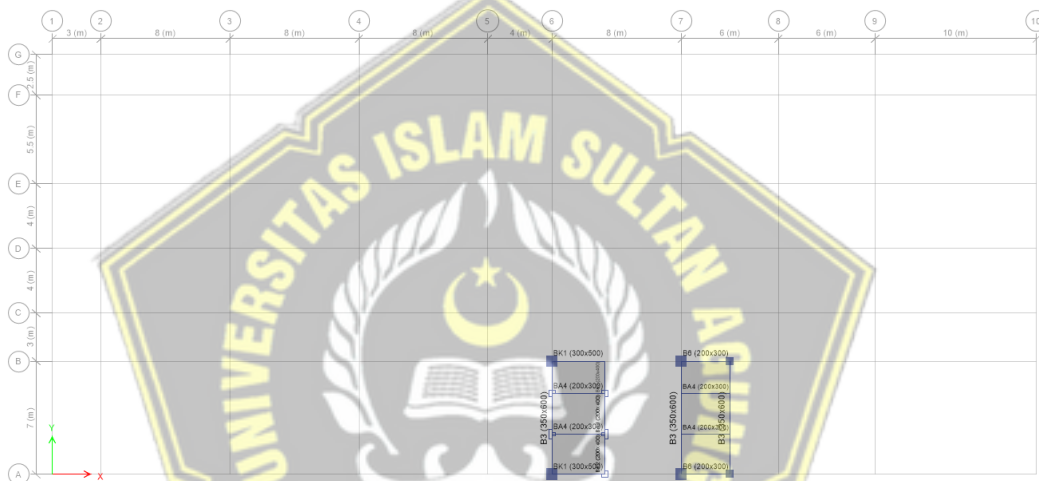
Denah Lantai 5 (EL. +16.00)
